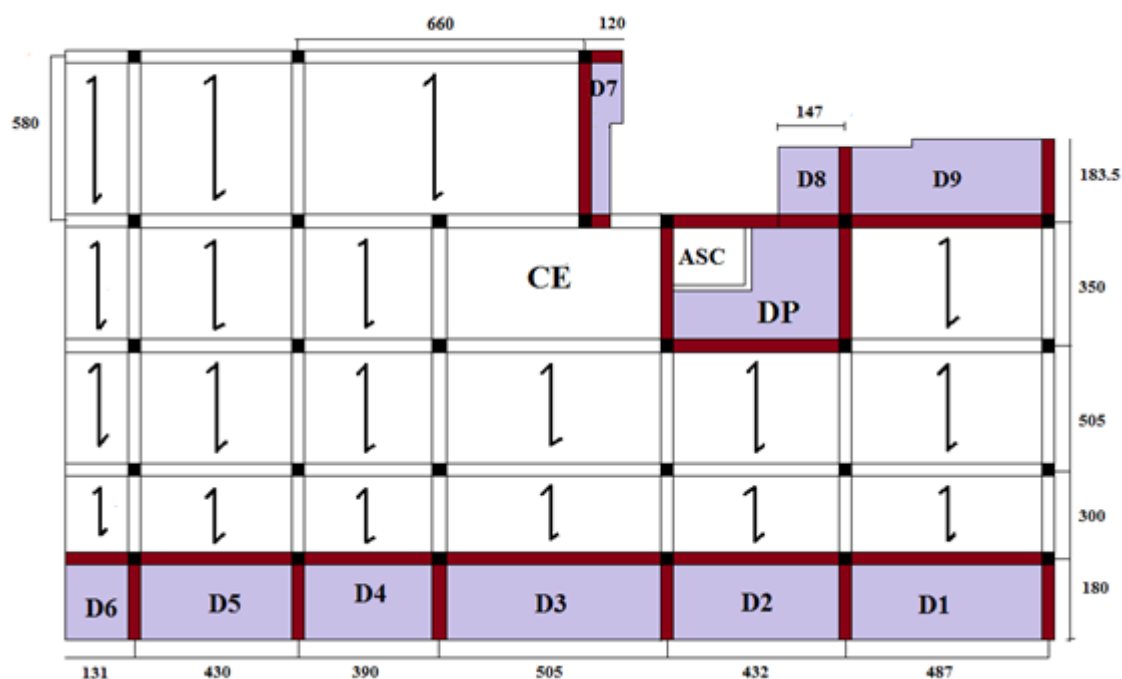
Position des différents types dalles pleines (niveau 1^{er} étage)
